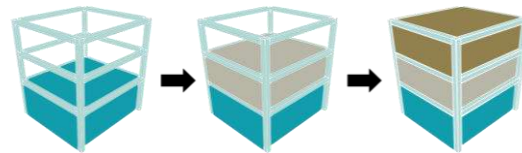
Concepto de vivienda de estructura (Elaboración Propia, 2018)
